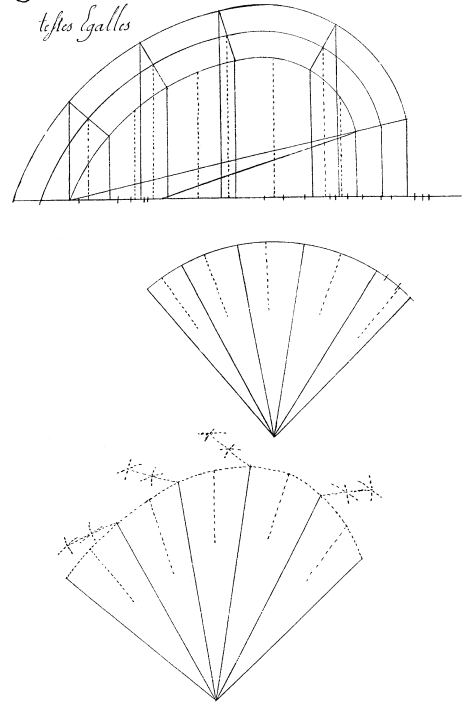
Tavola 65, Trompe Rampante ayant tel plan et telle Montee que lon Voudra faite sans lignes de pente et ayant les testes egales, ff. 64v.-65r.
